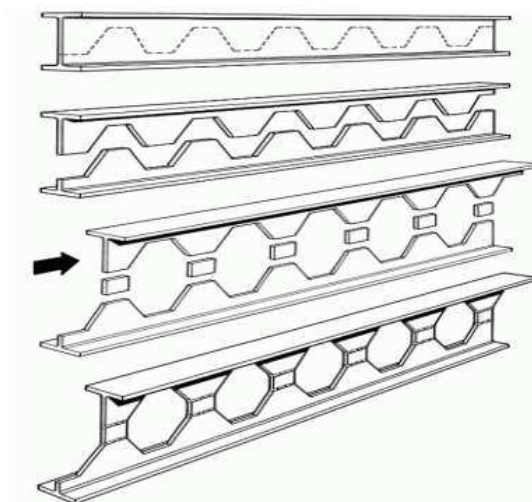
Vigas casteladas com chapas expansoras (GRUMBAUER, 2019).
